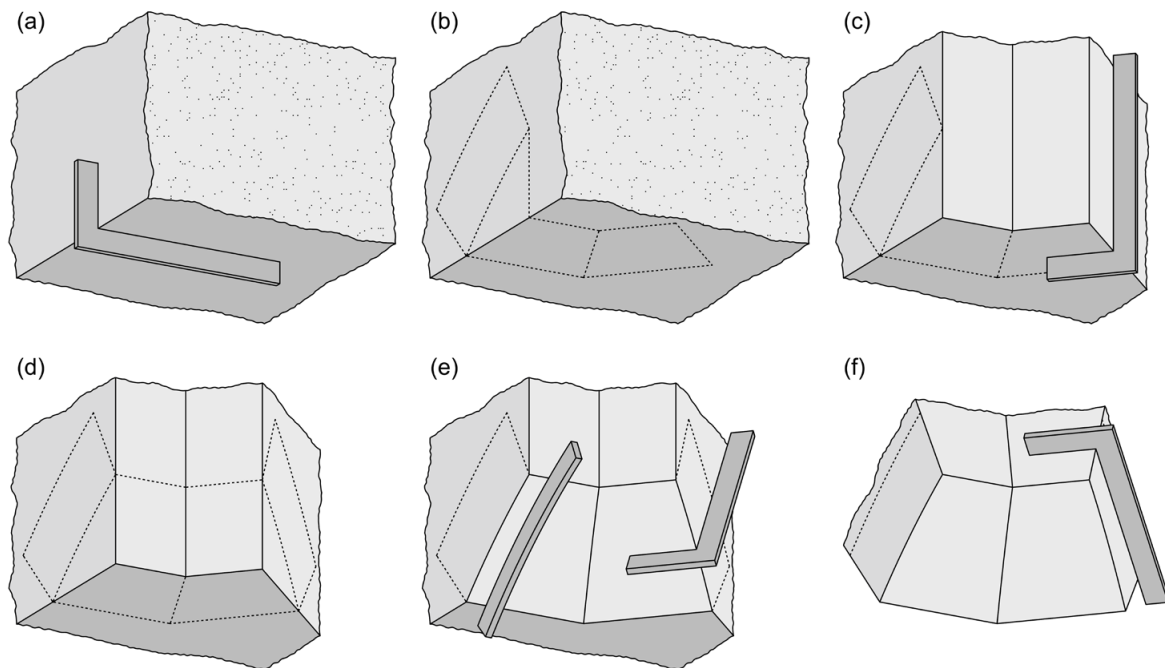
Labra por robos de una dovela de tipo C: (a) Labra de dos caras planas, horizontal y vertical, ortogonales entre sí, sobre un bloque de piedra desbastado. (b) Dibujo de la planta y la sección de la dovela sobre las caras horizontal y vertical. (c) Labra de la cara vertical opuesta y dos caras verticales auxiliares. (d) Dibujo de la sección de la dovela sobre la cara vertical opuesta. (e) Labra de las dos caras de intradós cilíndricas, comprobando la correcta ejecución con una cercha o una escuadra. En esta fase es fundamental no rebasar el plano diagonal del rincón, para no malograr la dovela. (f) Labra de los lechos planos, ortogonales a las caras verticales.
